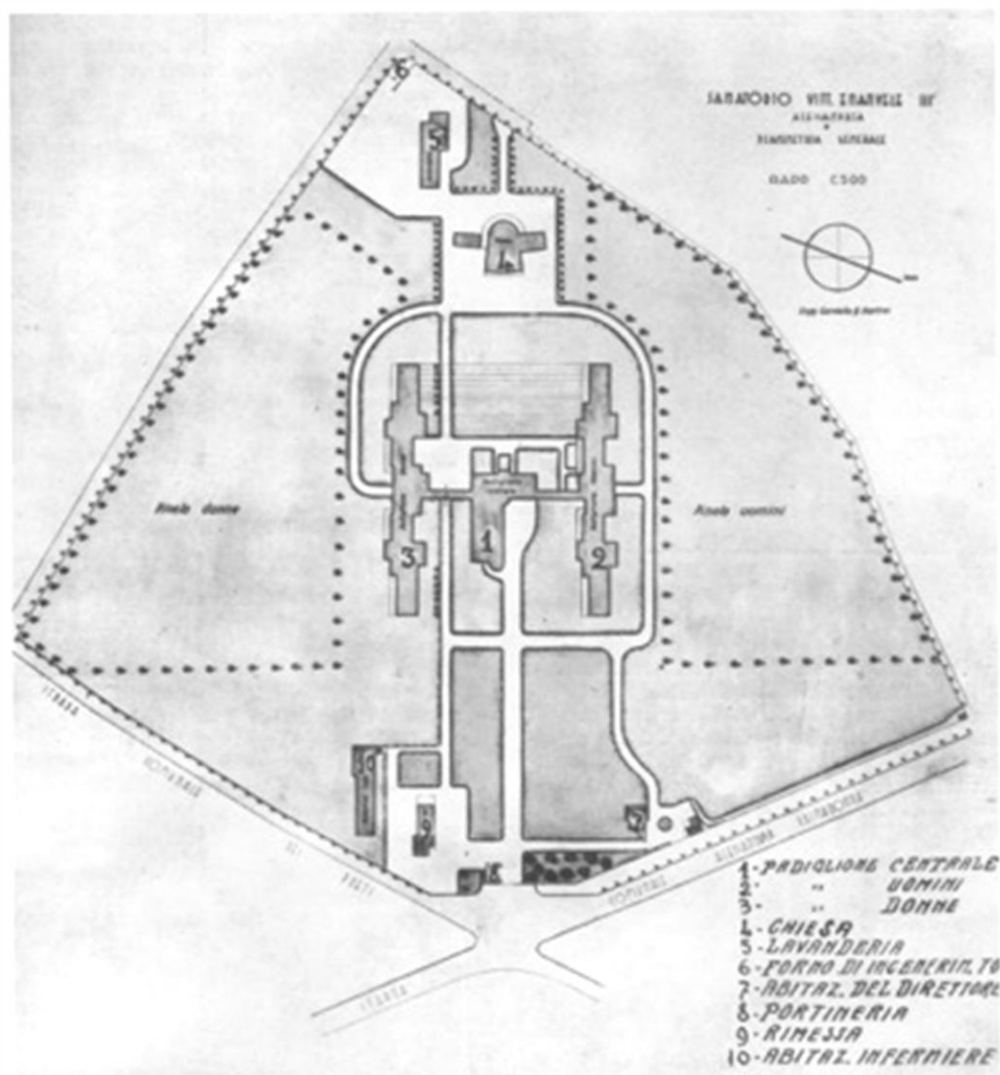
Planimetria di Progetto (da Alexandria", 1936).
